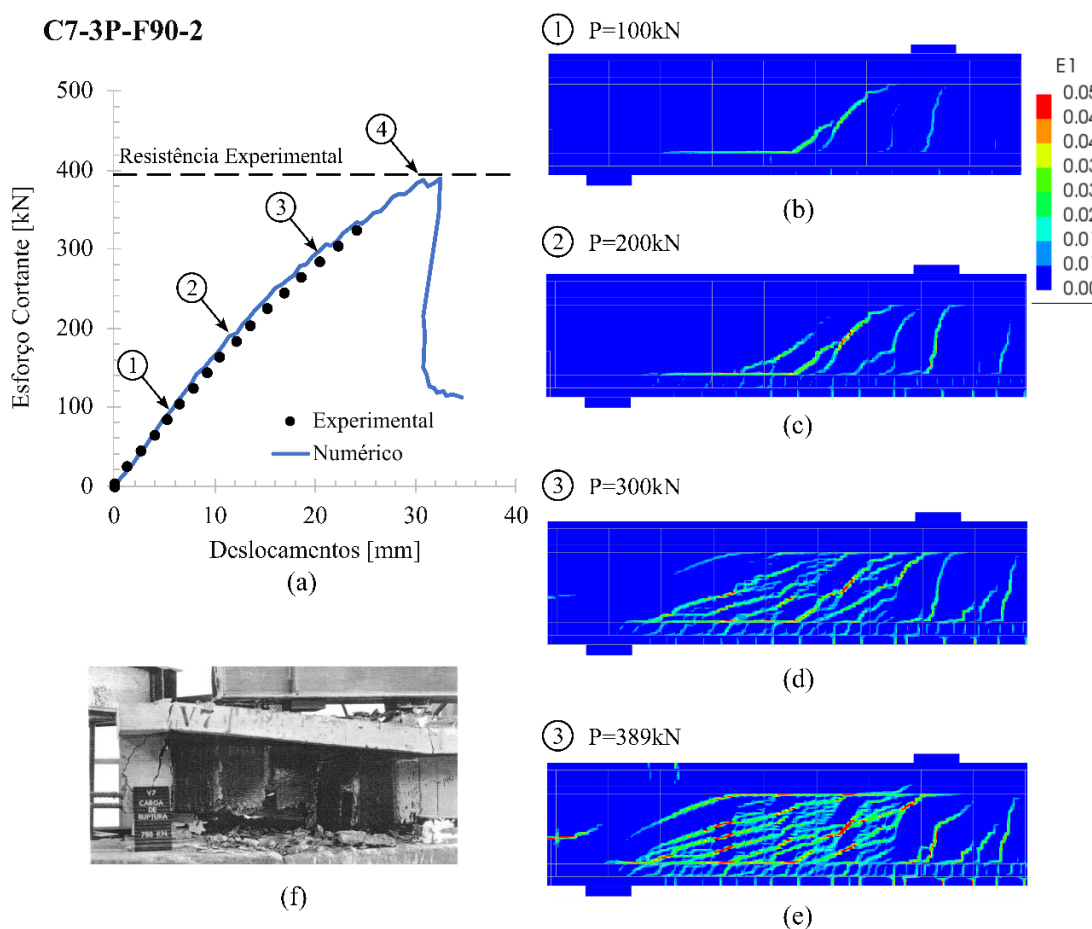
Esforço cortante e deslocamento no meio do vão obtidos numericamente e padrão de fissuração para a viga C7-3P-F90-2.
